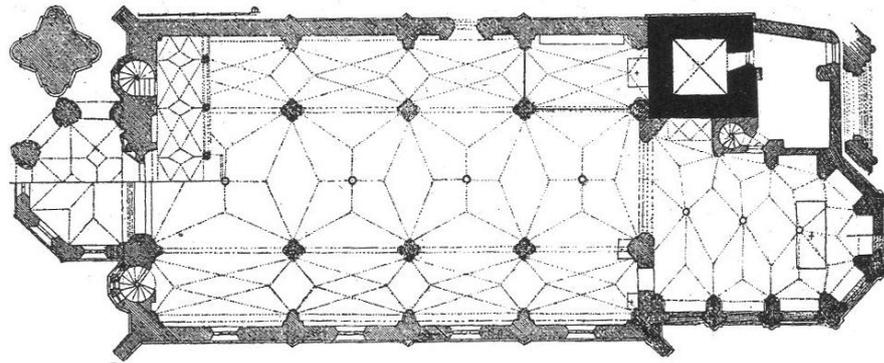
Hall in Tirol, St. Nikolaus. Grundriss mit rekonstruierten Gewölben. Bild: Egg 1970, S. 66.
